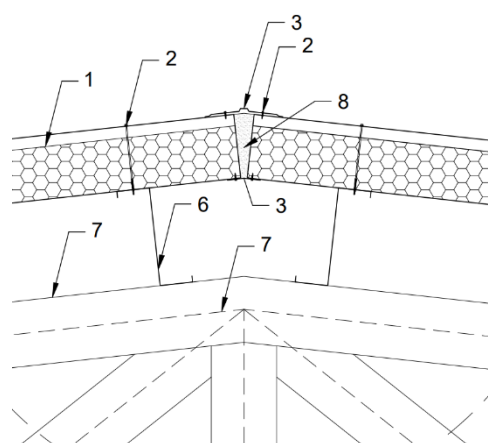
Przekrój poprzeczny płyty warstwowej dachowej
